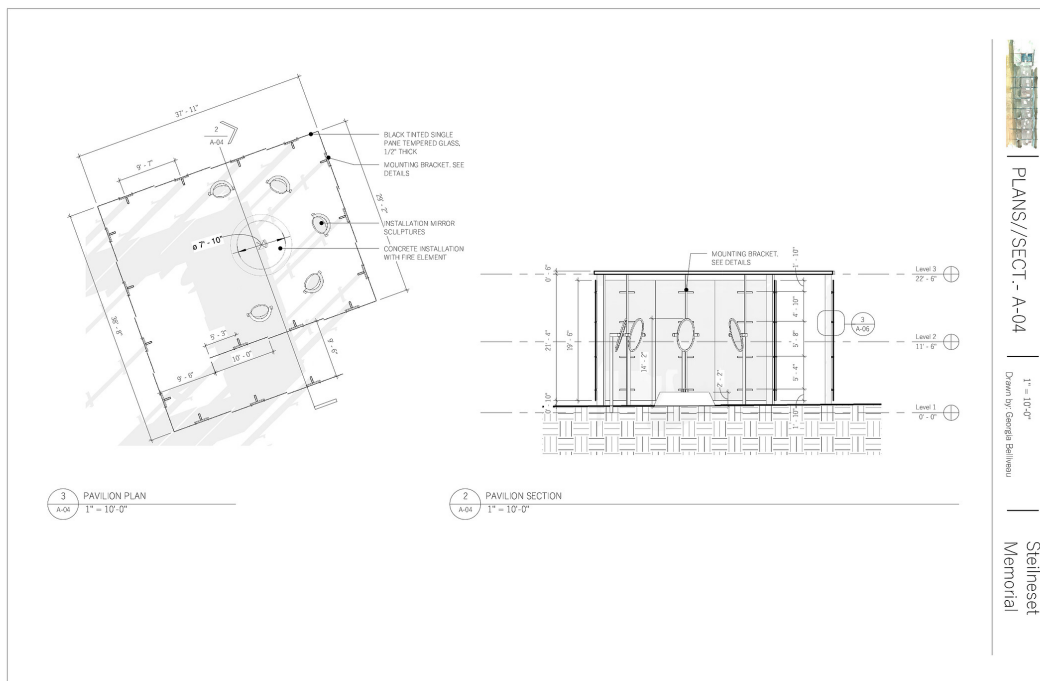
Pabellón para la obra de Bourgeois. Plano arquitectónico (planta y sección).
